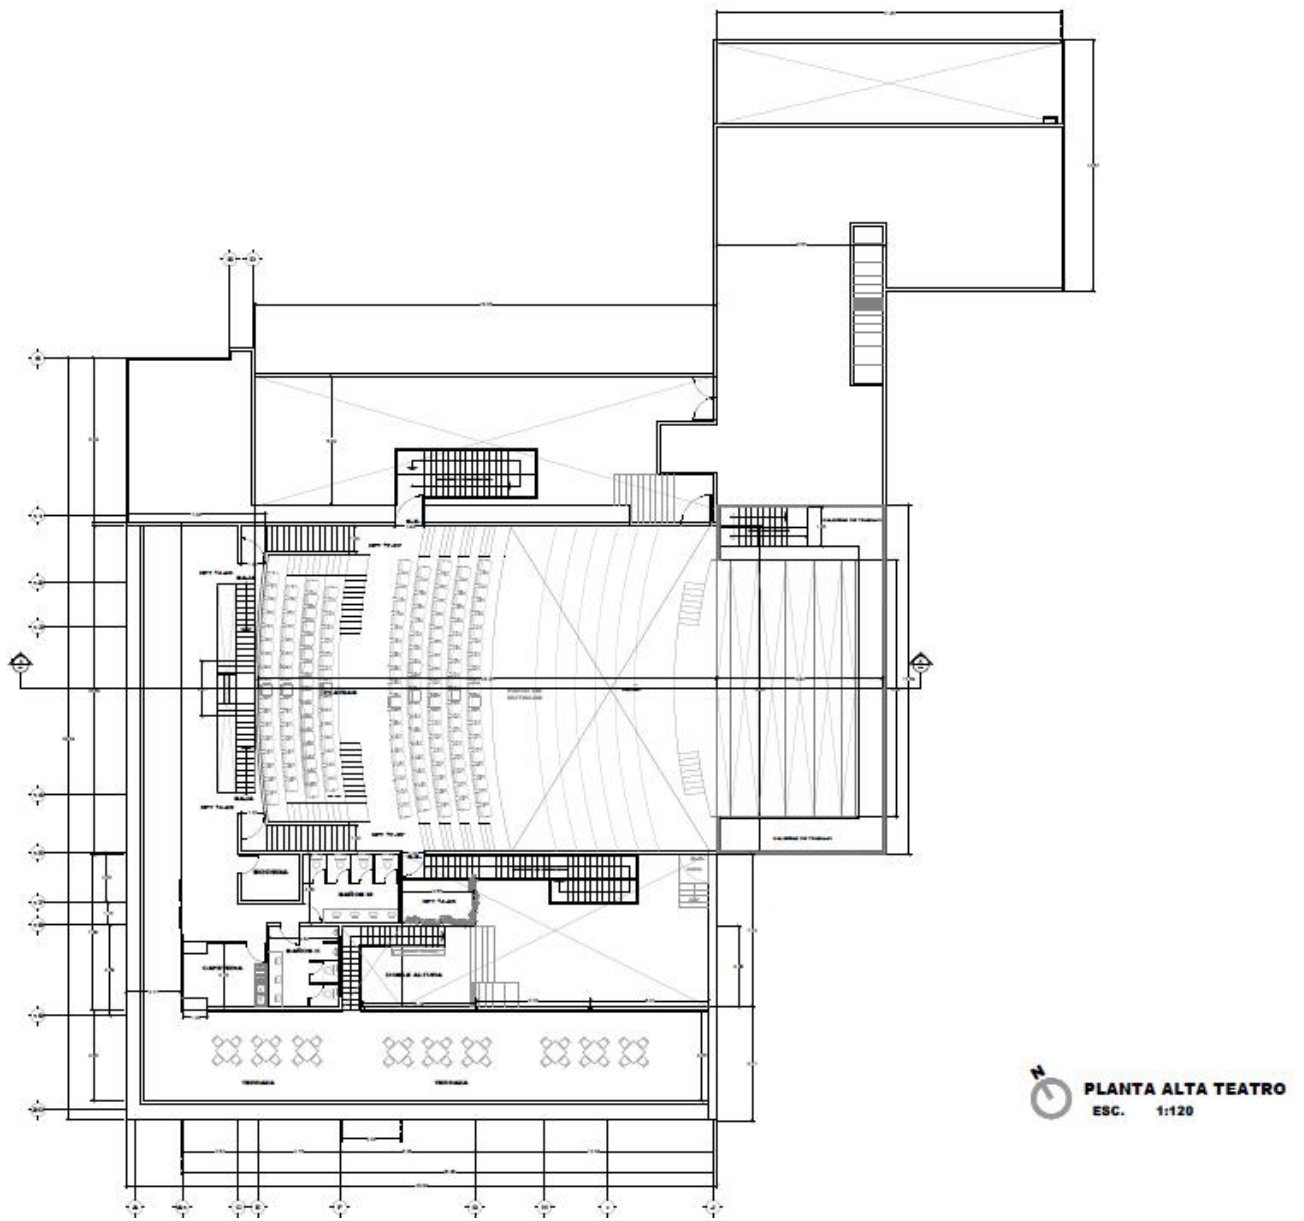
Planta arquitectónica alta (Fuente: Propia).
